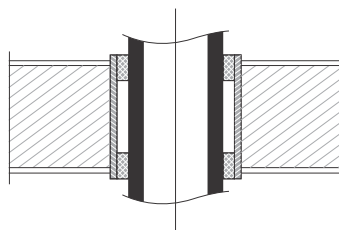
Переход трубы KAN-therm через строительные конструкции
